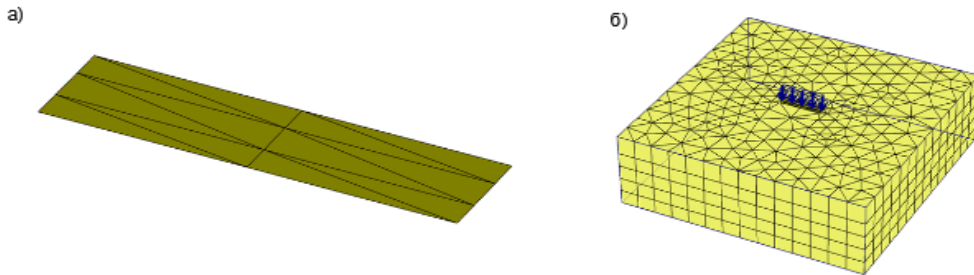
Розрахункова модель підсиленого фундаменту у варіанті умовного фундаменту (а) та розташування моделі під дією вертикального навантаження в масиві ґрунту (б)
